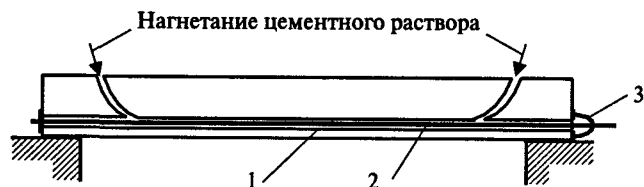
Создание предварительно напряженного железобетонного элемента с натяжением арматуры на бетон: 1 — канал; 2 — напрягаемая арматура; 3 — домкрат
